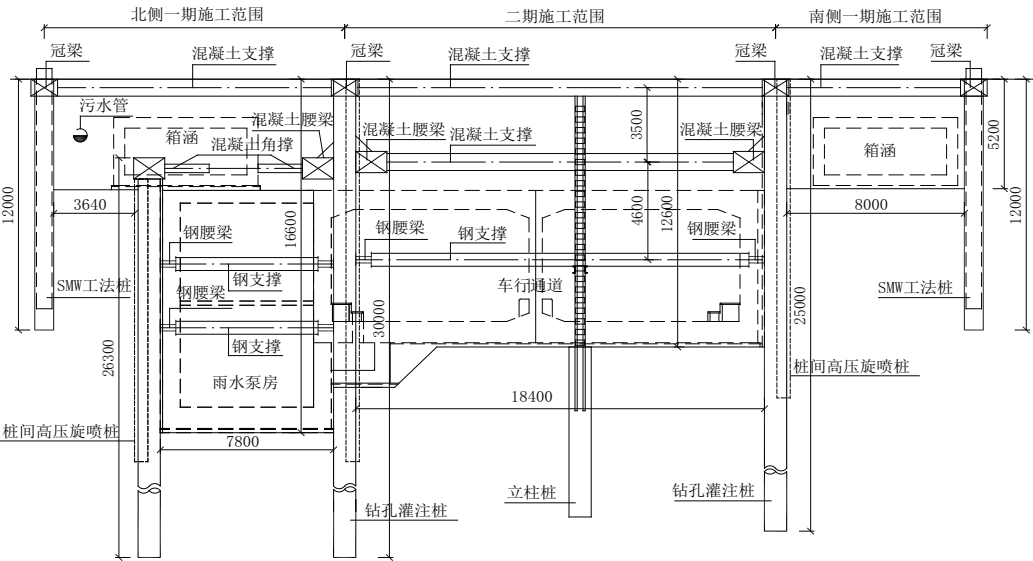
雨水泵房处共建基坑支护横断面图(单位:mm)
